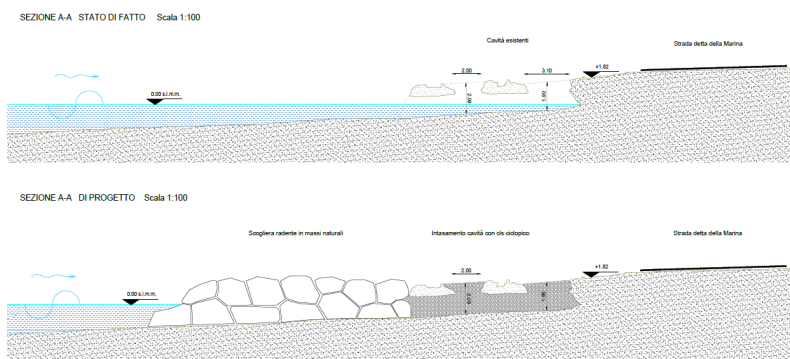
Elab. A-I-10-5 Area intervento 10 – Intasamento cavità
